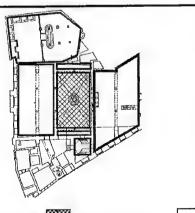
مسقط أفقى جامع شيخو [115:161]
